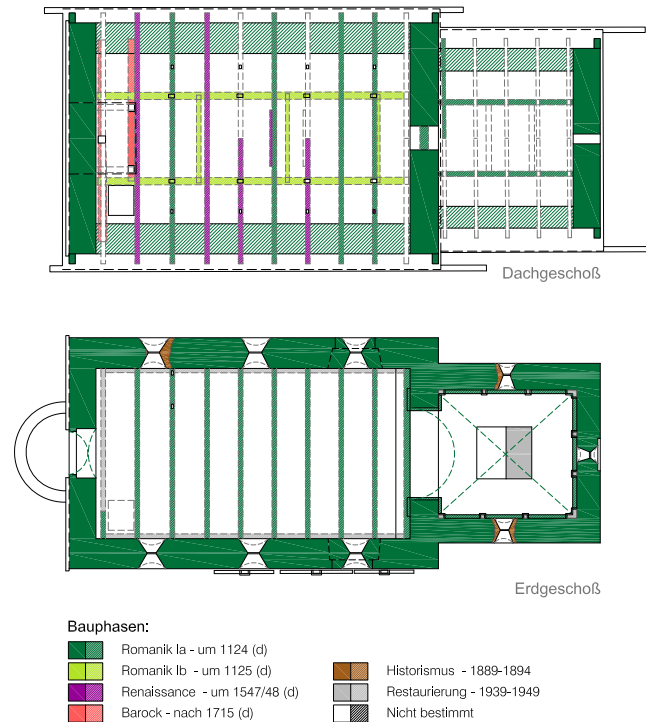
Pürgg, Johanneskapelle, Baualtersplan Erd- und Dachgeschoß, Martin Mittermair 2022 (nach Vorlage Inst. für Baukunst und Bauaufnahmen/TU Wien 1997)
